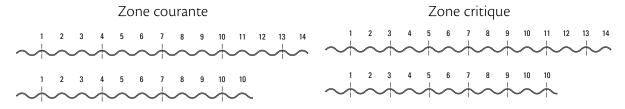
Implantation des fixations sur une couverture en tôles ondulées de 14 et 11 ondes
